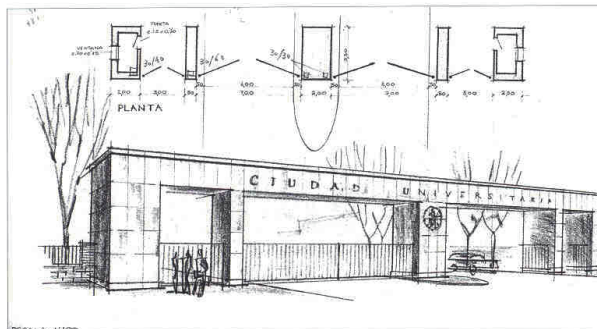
Planta y alzado de la puerta de acceso principal a la Ciudad Universitaria de Zaragoza.
